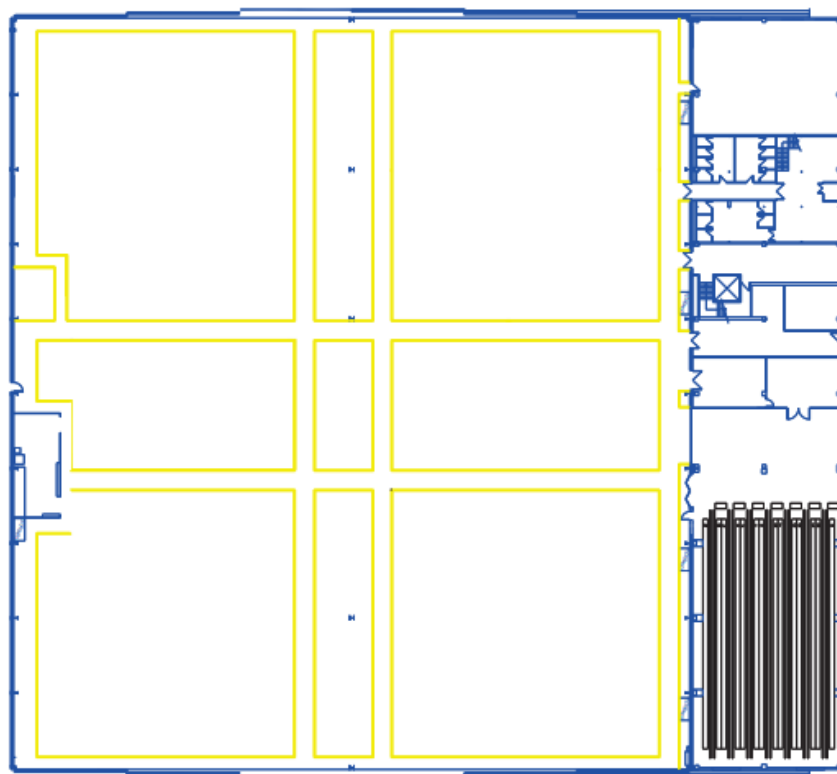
Plano general Nave 12 (Fuente: MRO SPN)
